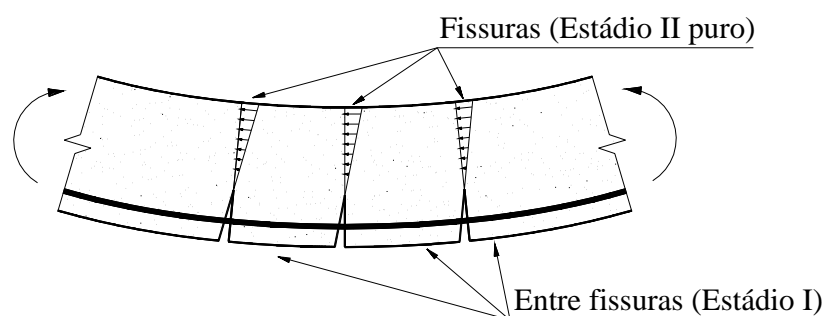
Representação esquemática do comportamento de uma viga de concreto armado submetida à flexão simples – Estádios I e II.
